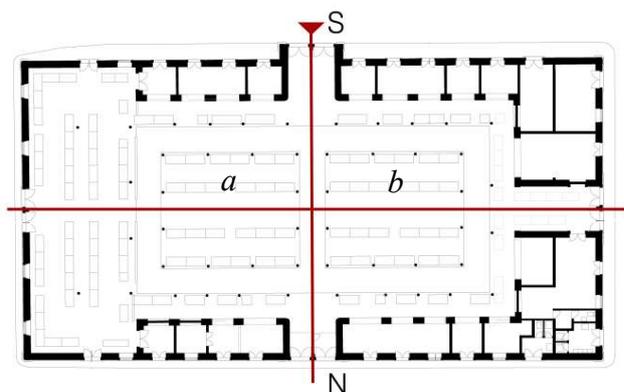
Planta esquemática: eixos estruturantes
